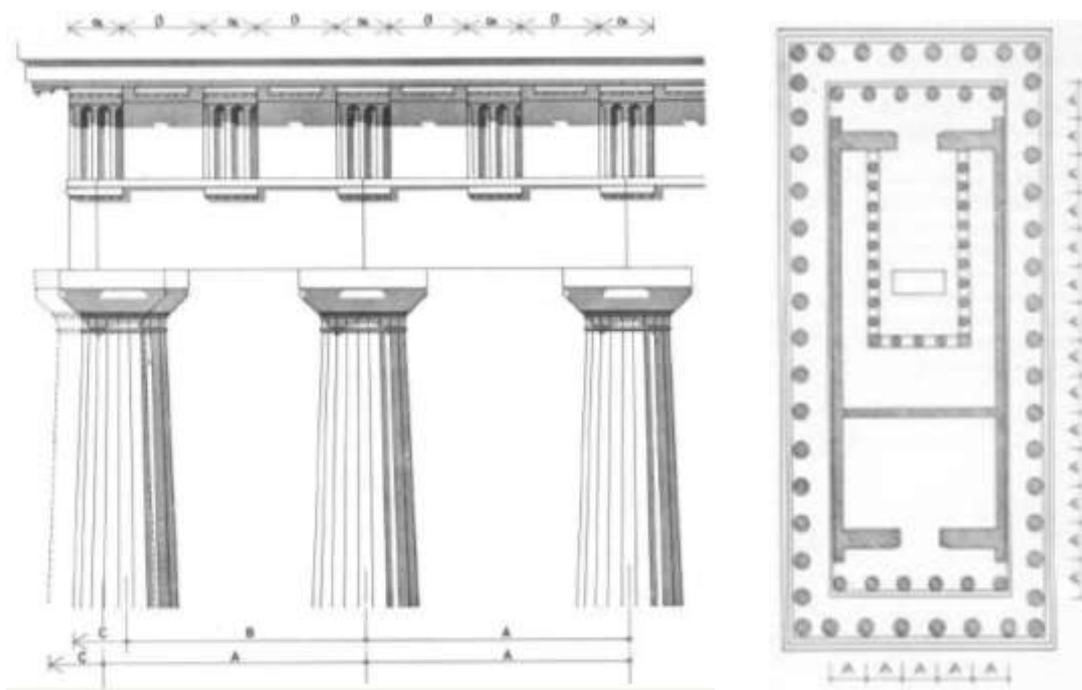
Esquema da relação entre elementos construtivos típicos da arquitectura grega – alçado e planta.
